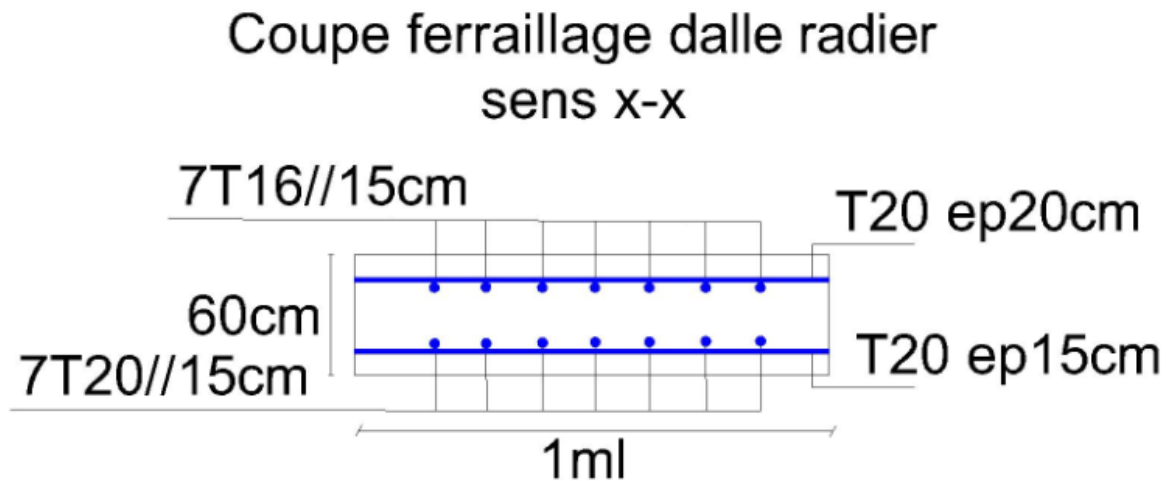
Coupe ferrailage dalle radier sens x-x
